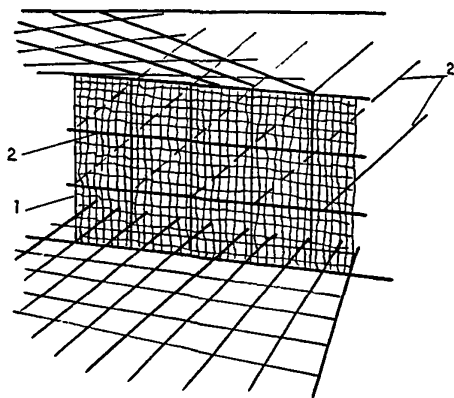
Внутренняя опалубка рабочего шва плиты:
